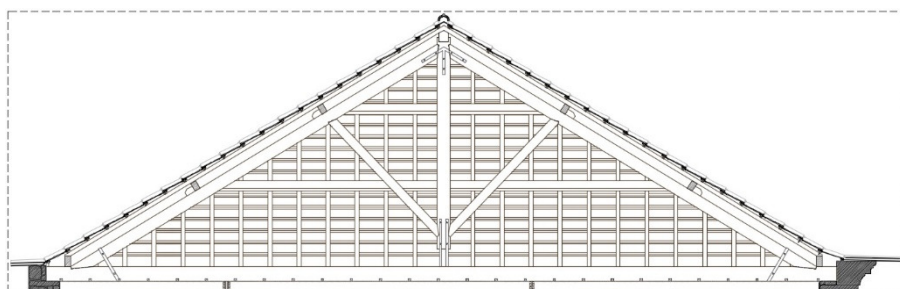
Pormenor da cobertura (s/escala) – (Autor)
